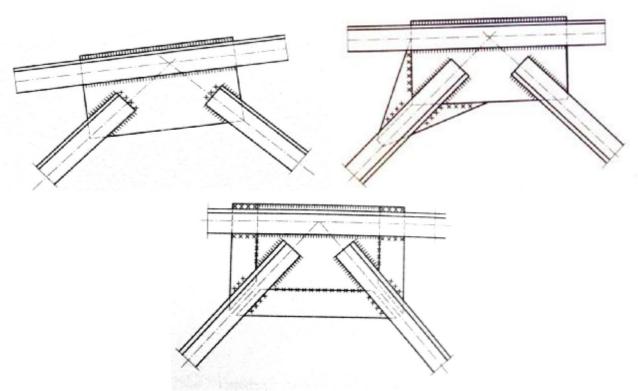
Усиление сварных швов в узлах крепления стержней стропильных ферм с использованием дополнительных фасонок
